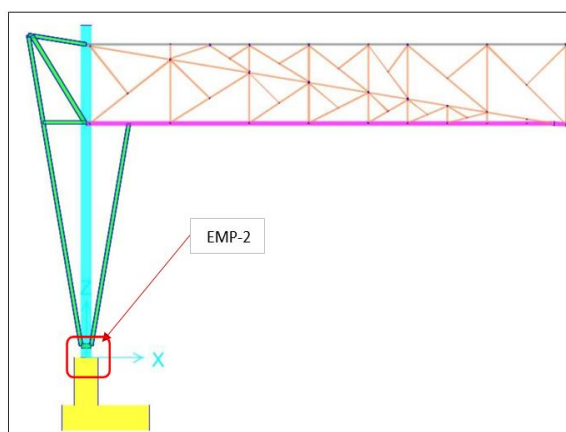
Vista de elevación en X del empotramiento - 2. Fuente: Solpesa SAC. (2023).
